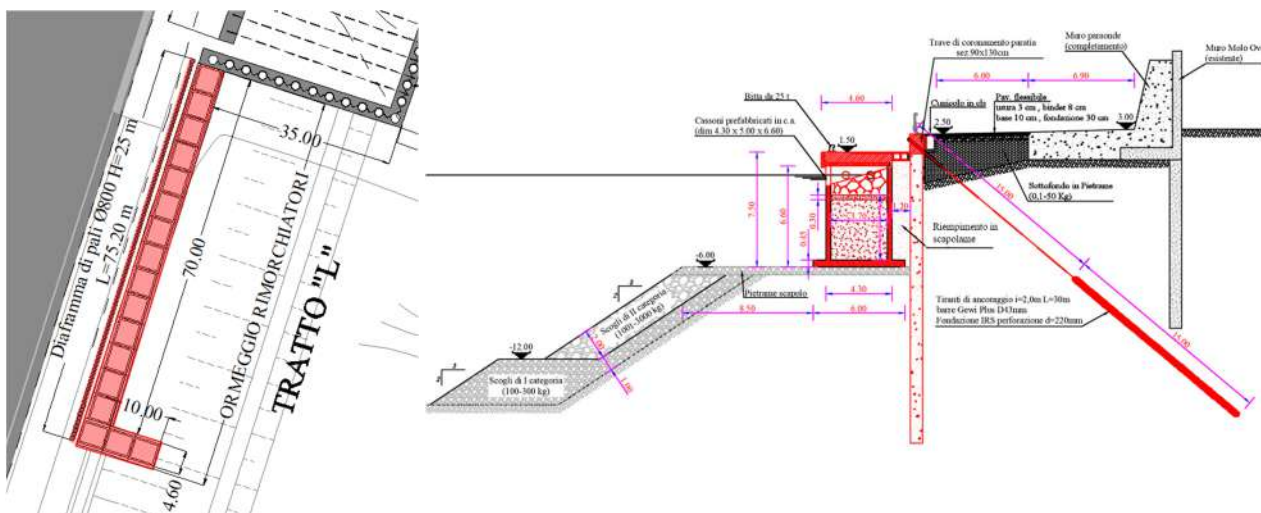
Stralcio planimetrico e sezione tipo del nuovo banchinamento per rimorchiatori
